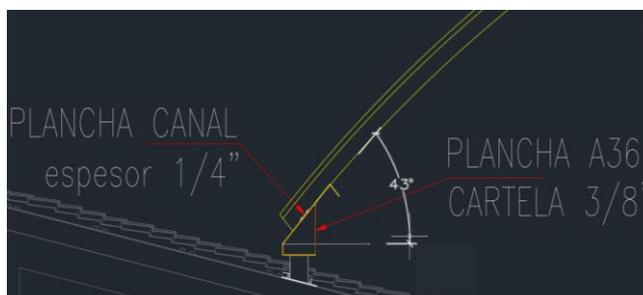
Detalle de plancha de acero A36 de $\frac{1}{4}$ " reforzada
